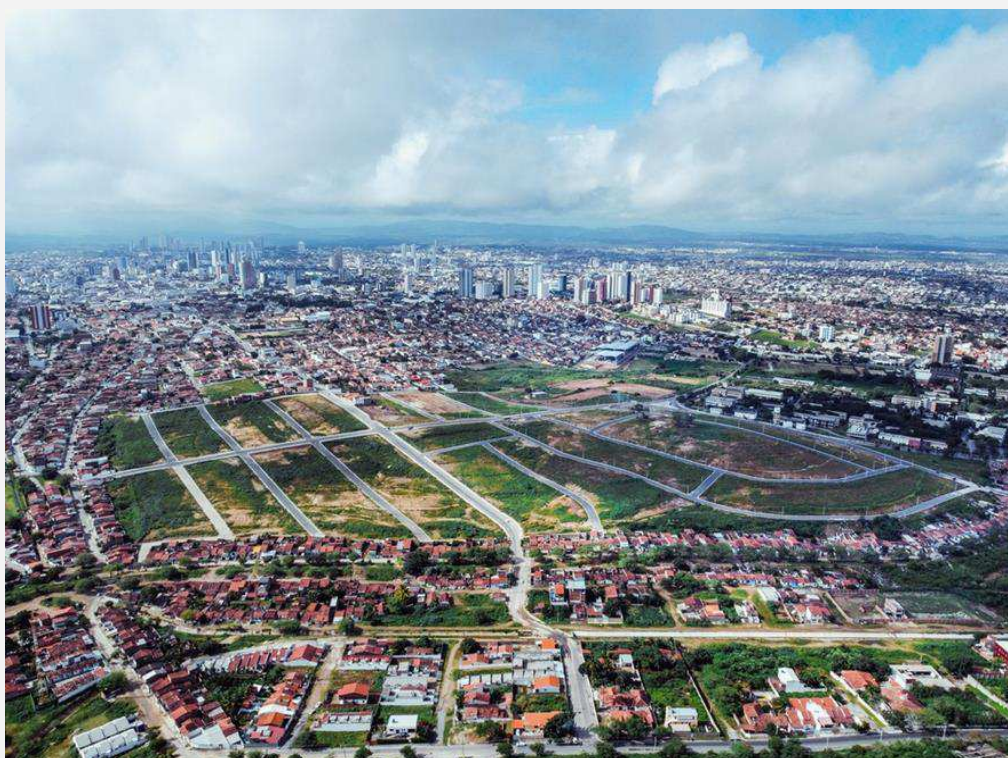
Vista aérea do Bairro Planejado Bento Bairro Conectado.
